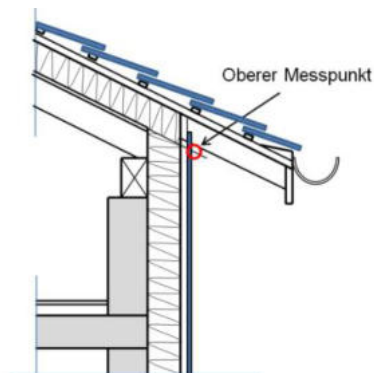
Schema oberer Messpunkt der Fassadenhöhe gemäss § 278 nPBG
